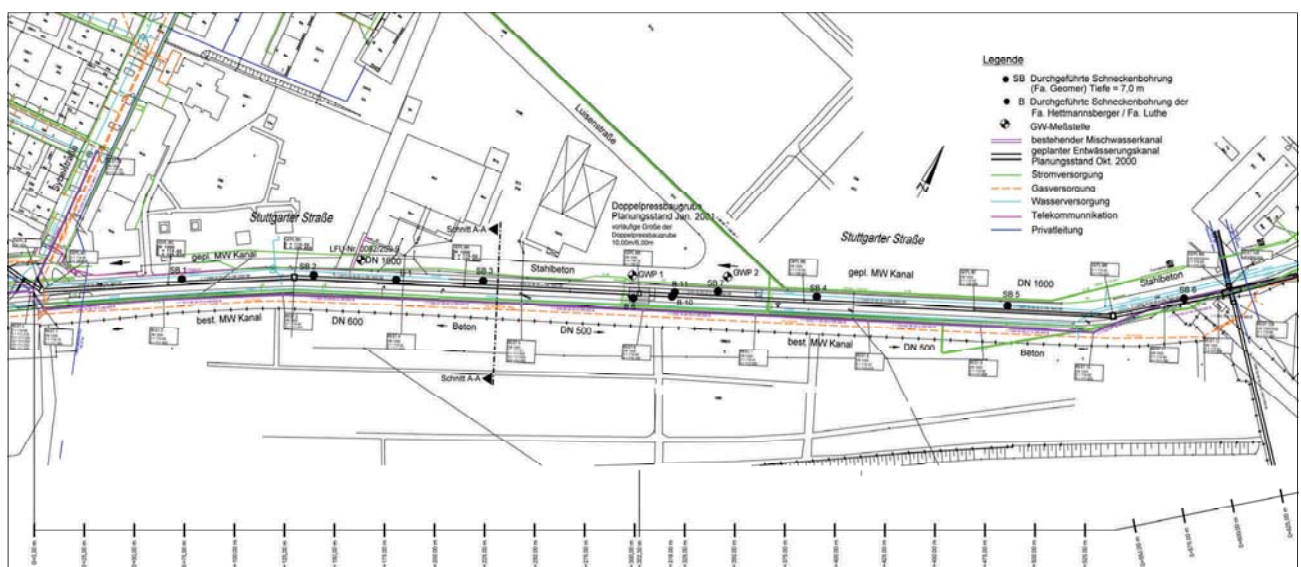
Lageplan Trasse mit Erkundungsmaßnahmen
